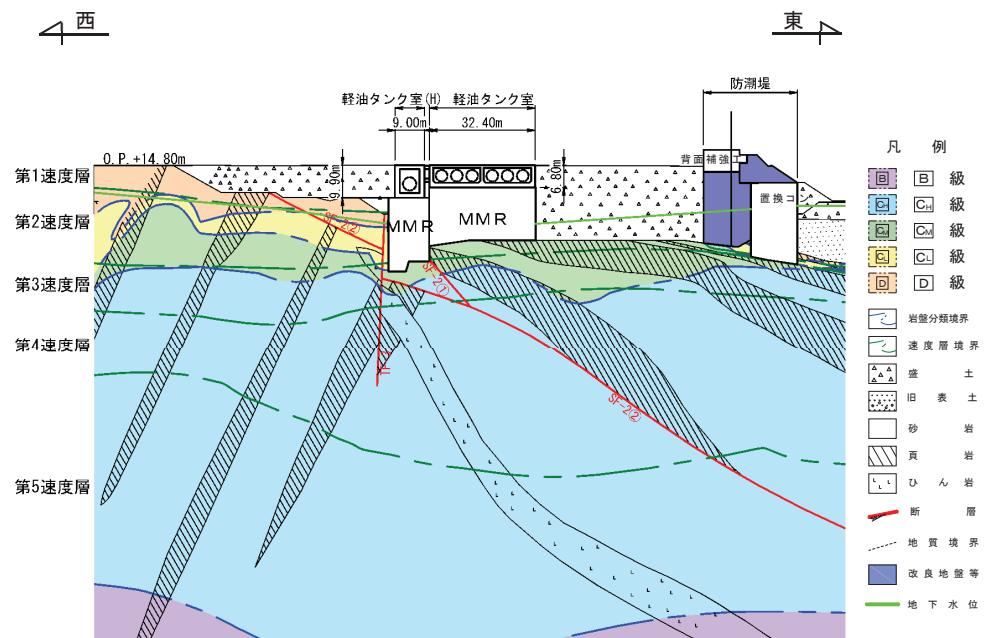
軽油タンク室地質断面図 (B-B, タンク室)
